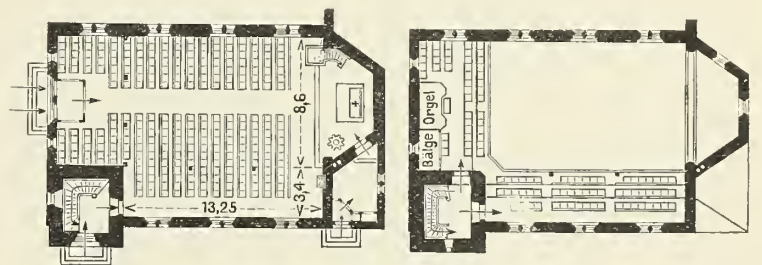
Grundriß zu ebener Erde. Abb. 18. Grundriß in Höhe der Emporen.
